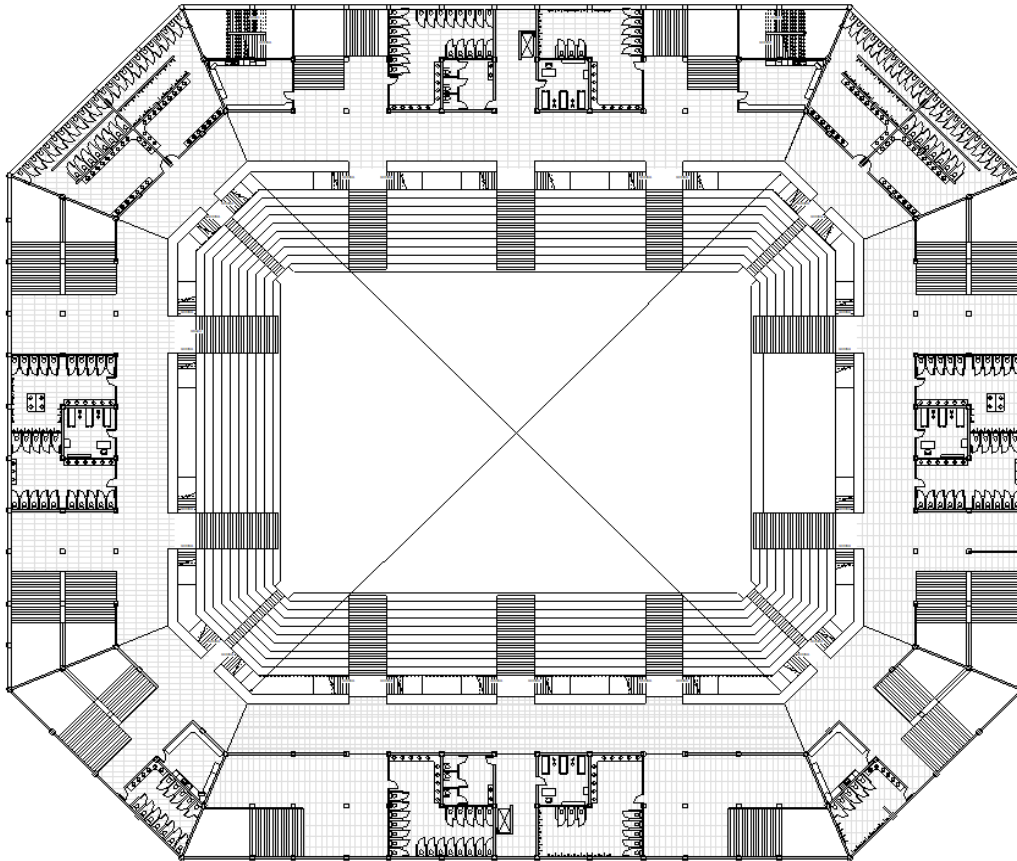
Vista en planta del primer piso. Fuente: elaboración propia.
